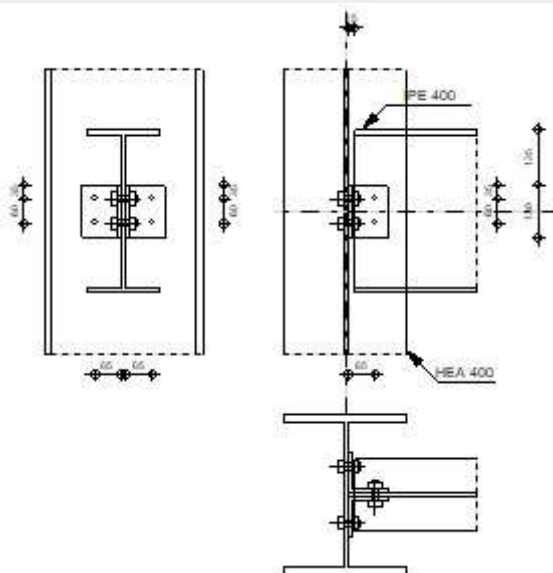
Représentation de l'assemblage Poteau de rive – poutre secondaire.
